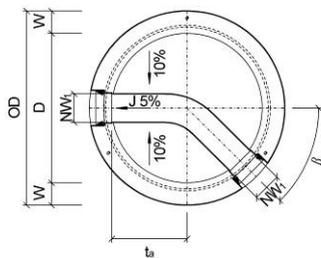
Grundriss CRENO Normschachtboden Typ 11
